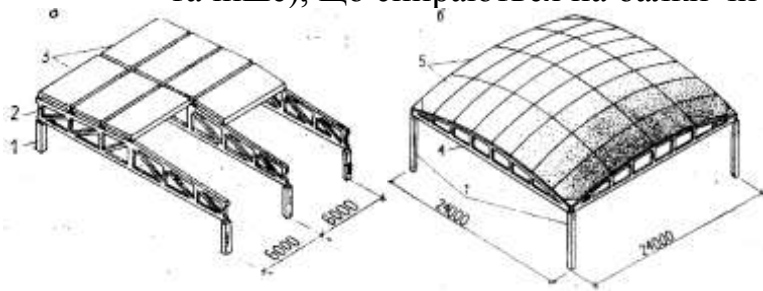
Конструктивні типи покриттів: а – плоске; б – просторове (в вигляді оболонки; 1. колона; 2 – ферма; 3 – плити покриття; 4 – контурна ферма; 5 – плити покриття з циліндричною поверхнею.
